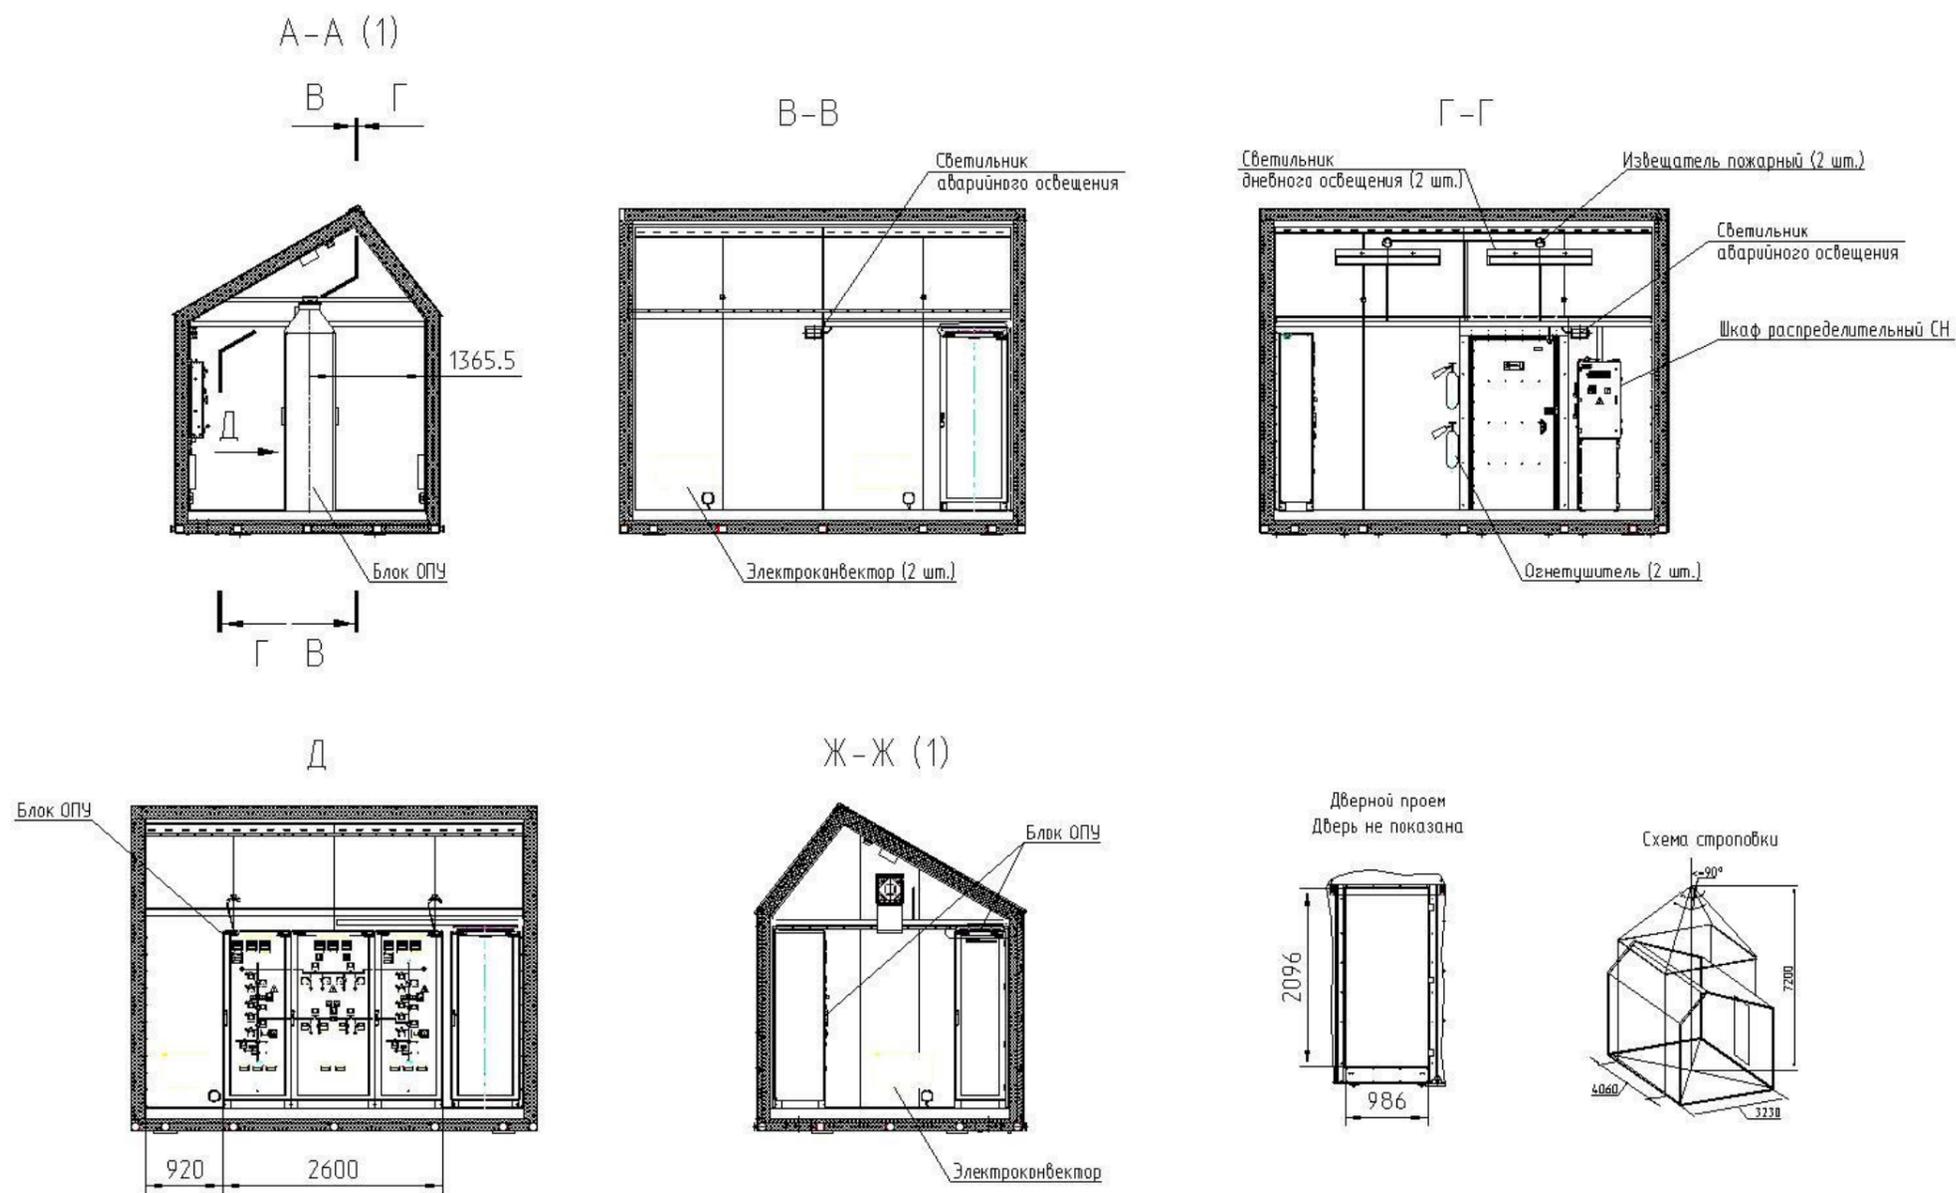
Габаритный чертеж модуля ОПУ типоразмером 4,8 м
